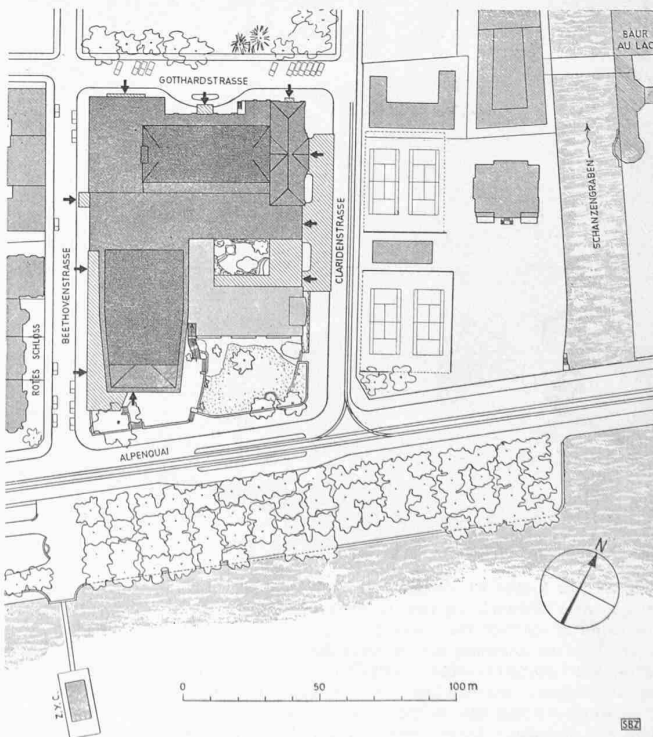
Lageplan von Tonhalle und Kongresshaus, Zürich. — 1:2500
